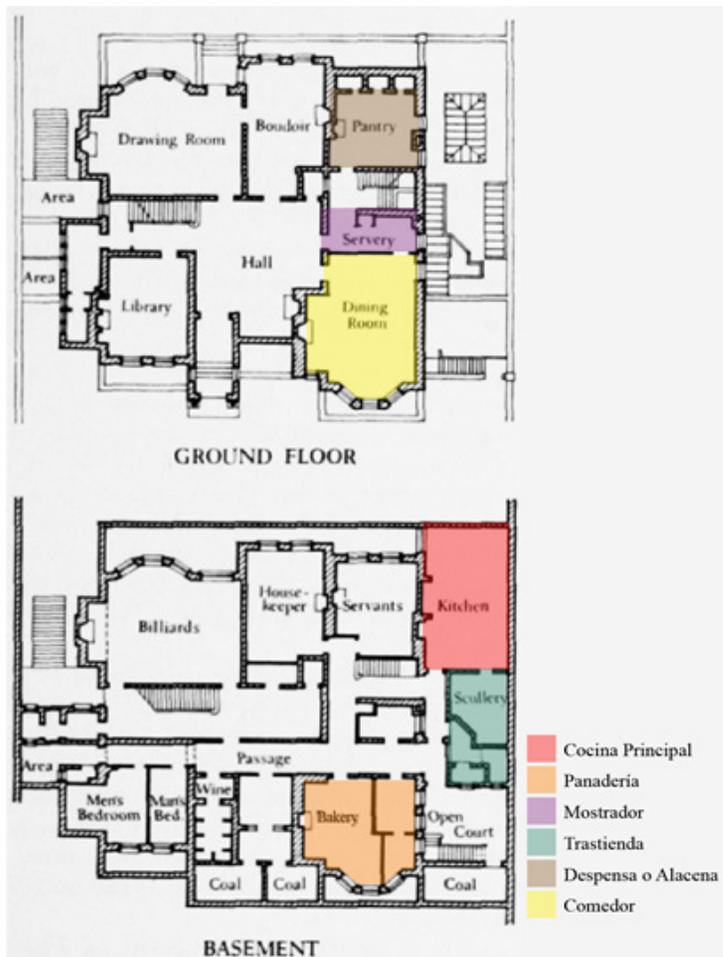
Plano de mansión inglesa construída en la primera mitad del s.XX
